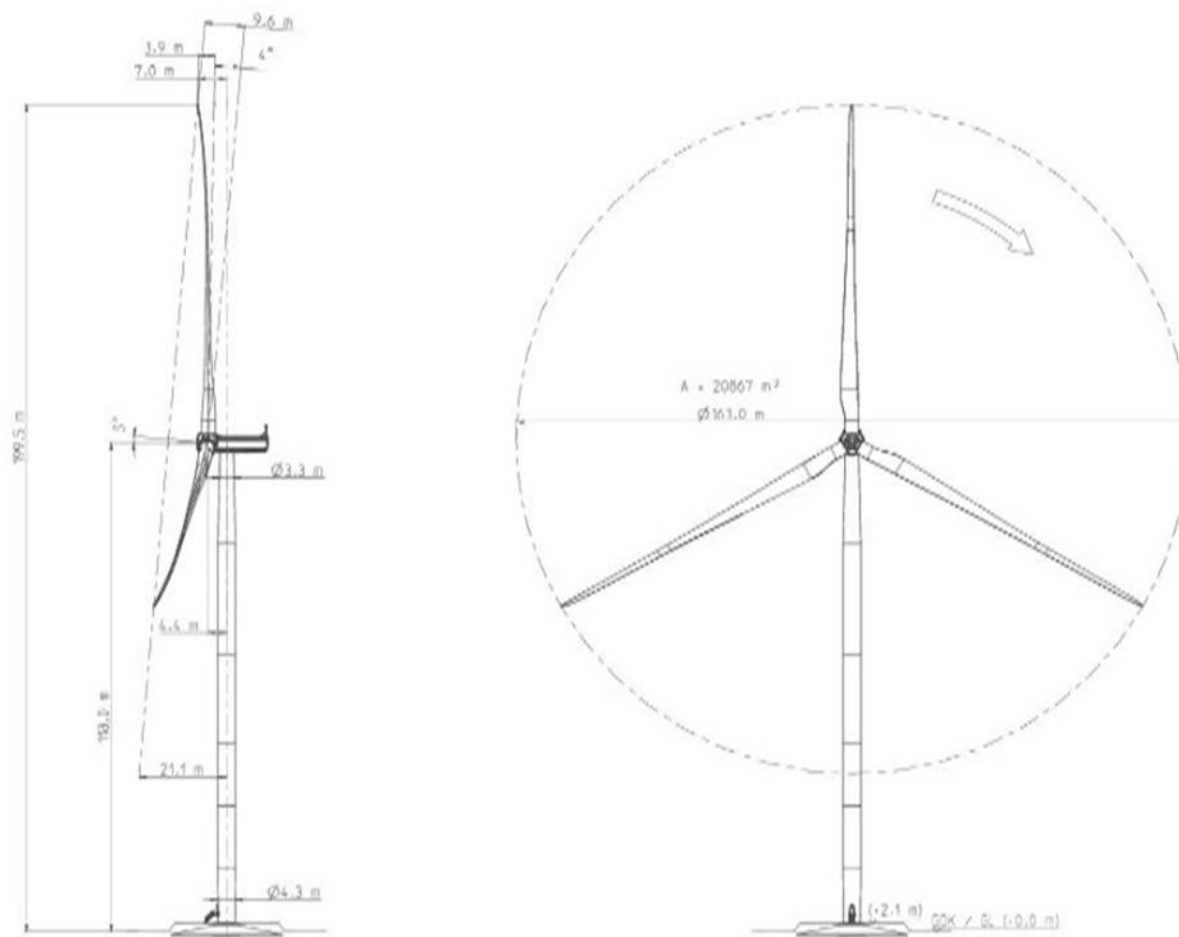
Plan en élévation de l'éolienne NORDEX N163/5.X TS118
